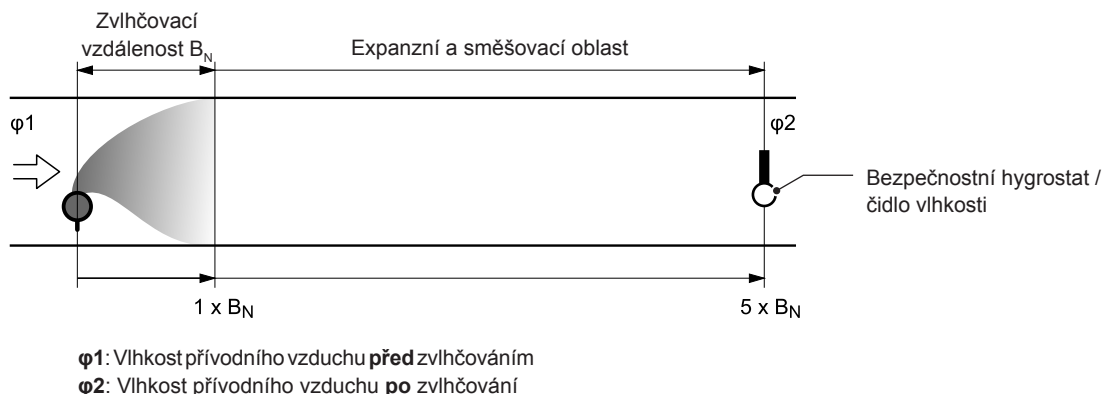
Přehled instalace parního systému prostorového zvlhčování
